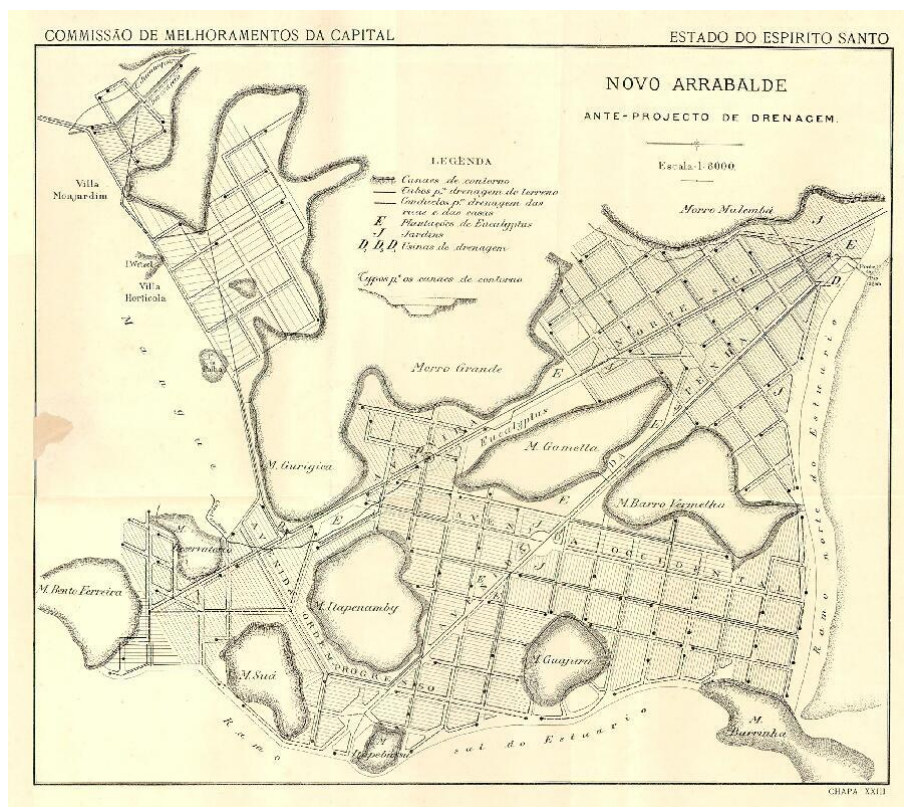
Projeto Novo Arrabalde de Vitória – Planta urbanística. Fonte: BRITO, 1943.
